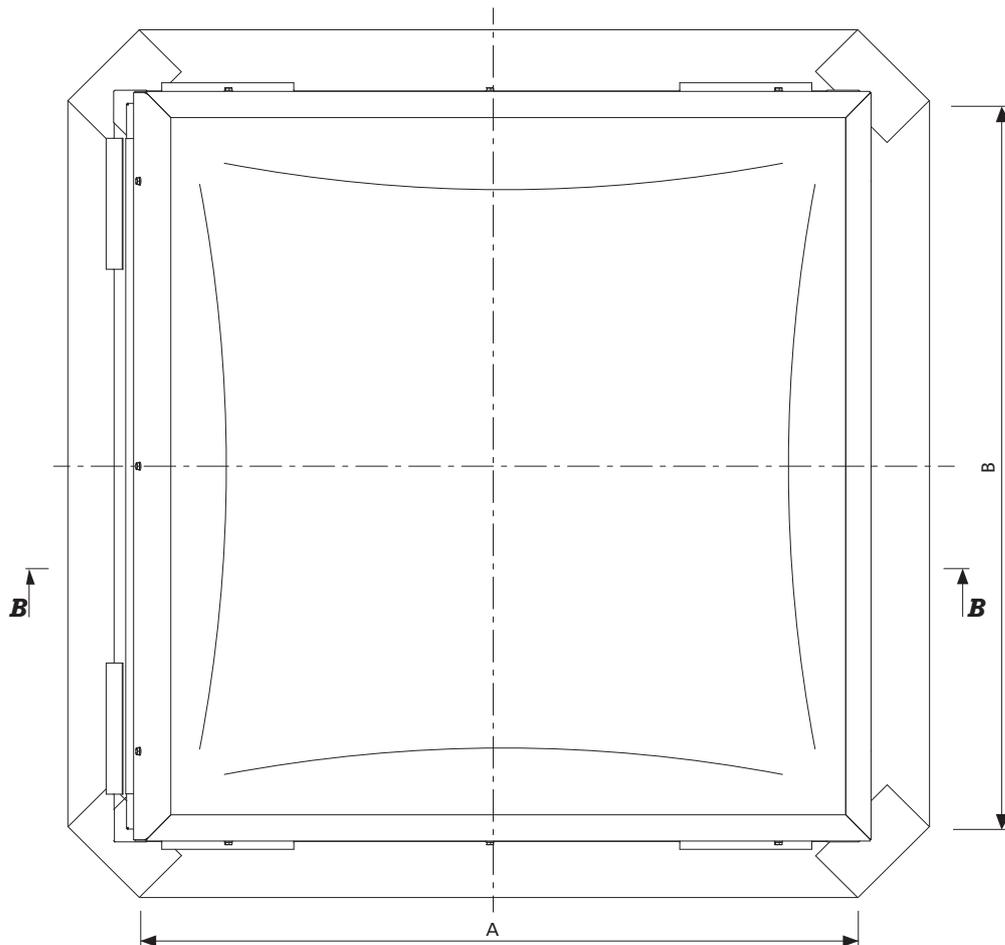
Vue de haut d'un lanterneau d'aération mcr PROLIGHT NG-A, dimensions en mm
